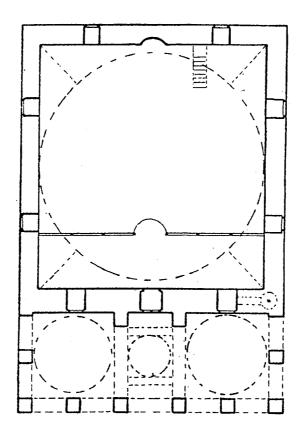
مسقط أفقي لمسجد قاسم باشا في ادرنه . (عن : Kuran).
